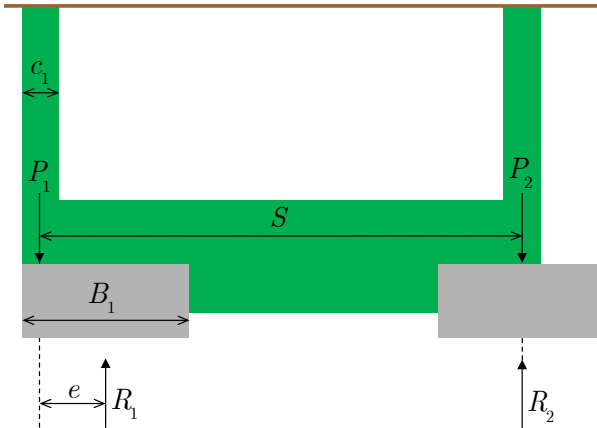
Zapata excéntrica con viga de vinculación – Vista
